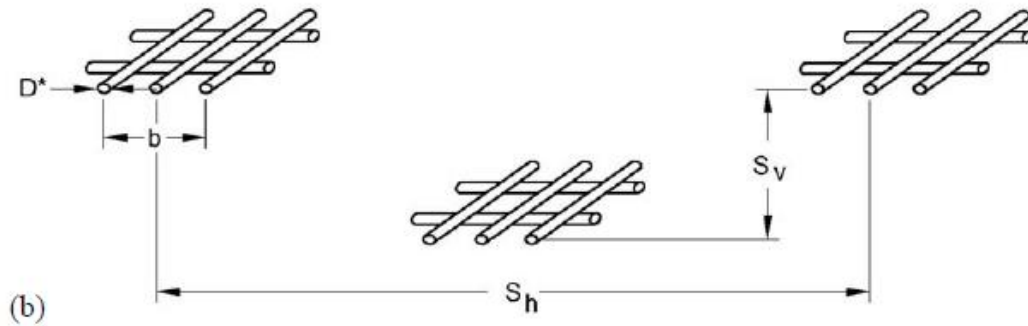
Sección típica de mallas de elementos de refuerzo
